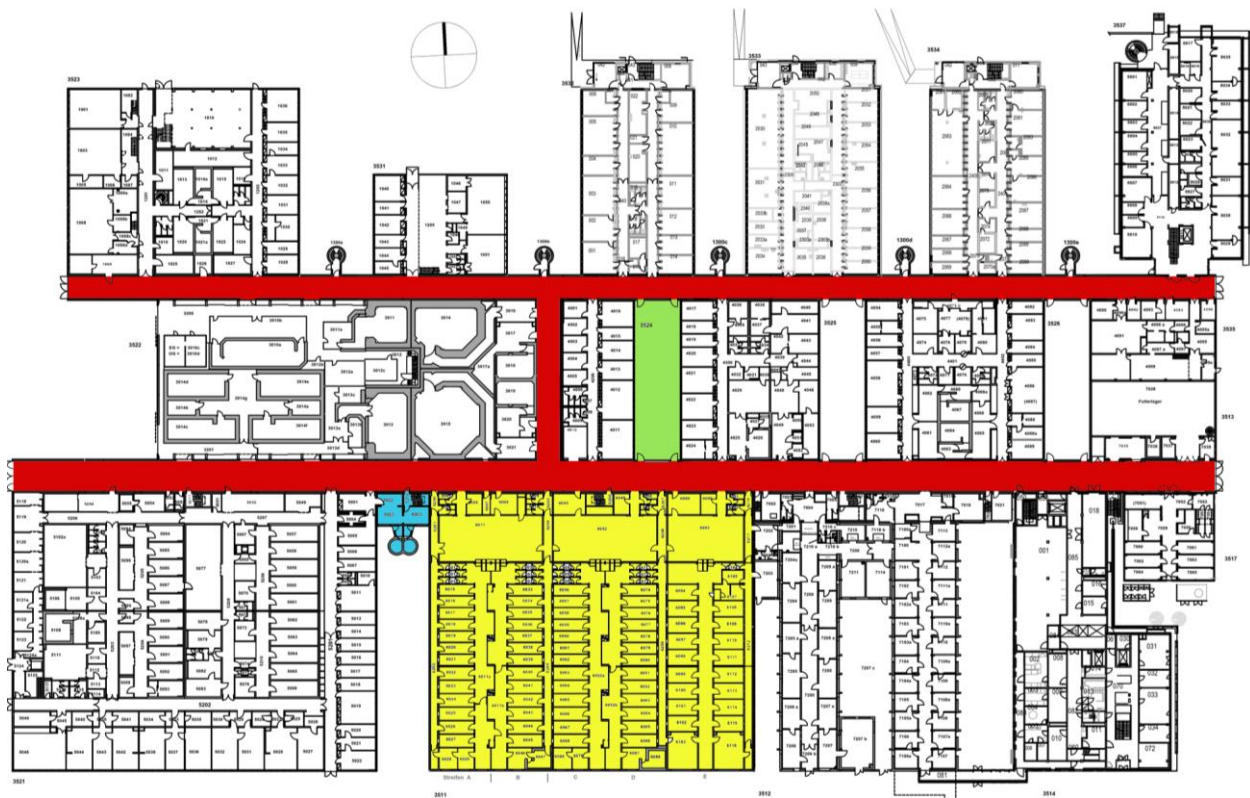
Gebäudekomplex 35, Erdgeschoss
